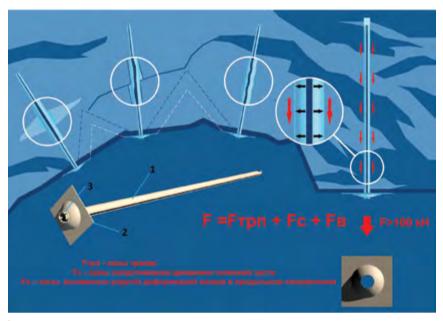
Принцип работы и общий вид самозакрепляющейся анкерной крепи
